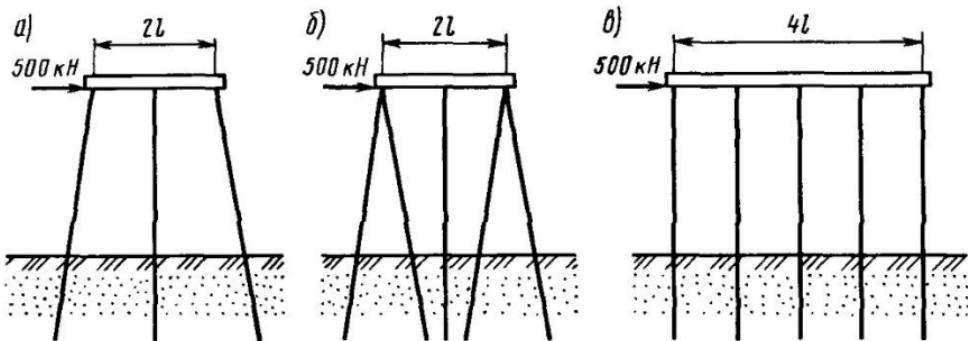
Плоские схемы фундаментов с расположением свай:
